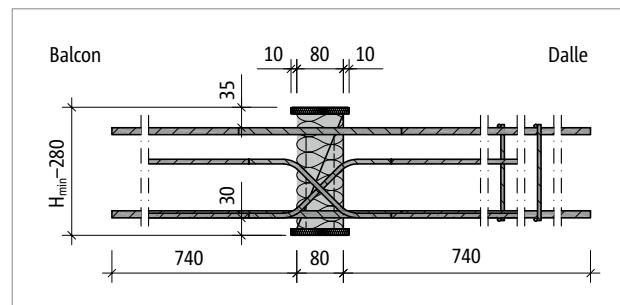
Schöck Isokorb® T types D-MM1-VV1 à MM5-VV1 à CV35 : coupe du produit
